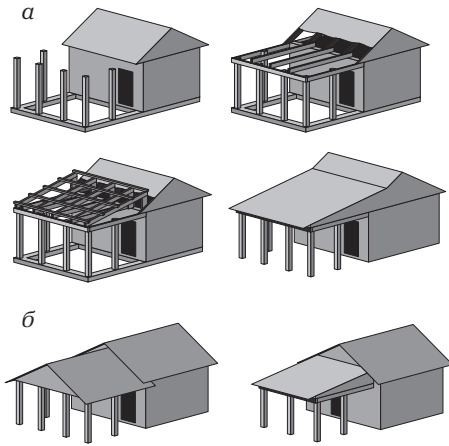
Сопряжение элементов кровли веранды и крыльца: а — со стороны скатов; б — с фронтальной стороны
